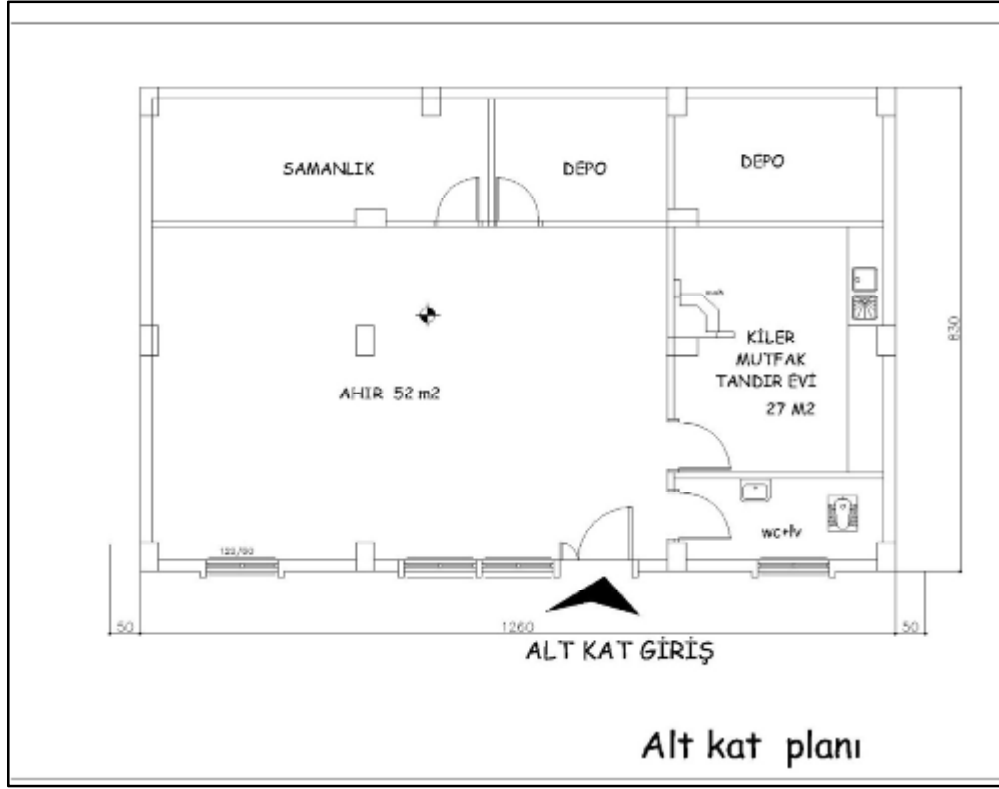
Tandır evlerinin vaziyet planında yerleşimi.
